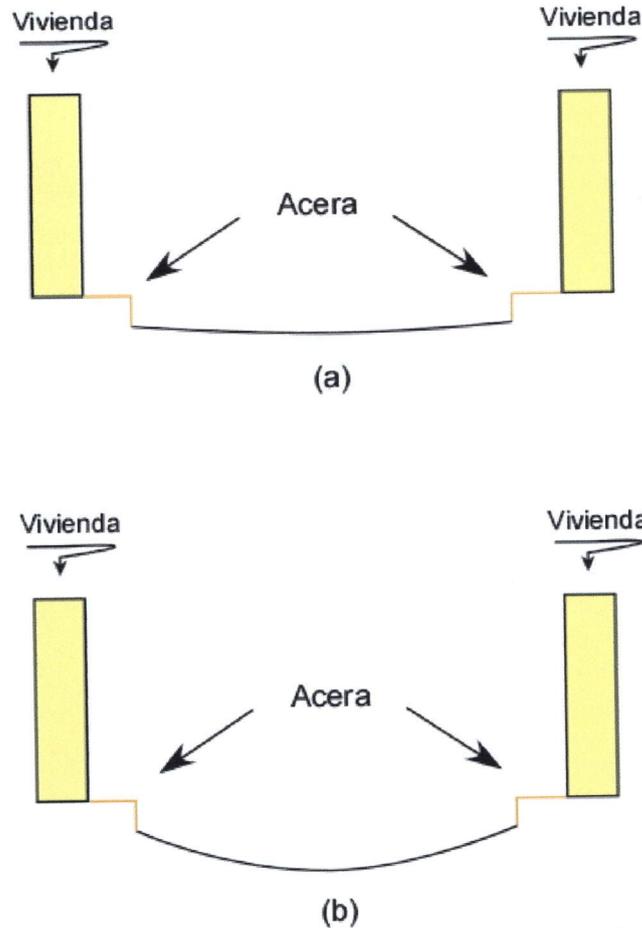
(a) Corte esquemático del perfil actual del Jr. La Mar. (b) Corte esquemático de cómo debería quedar el Jr. La Mar, después de pavimentarla en cóncava hacia arriba.
